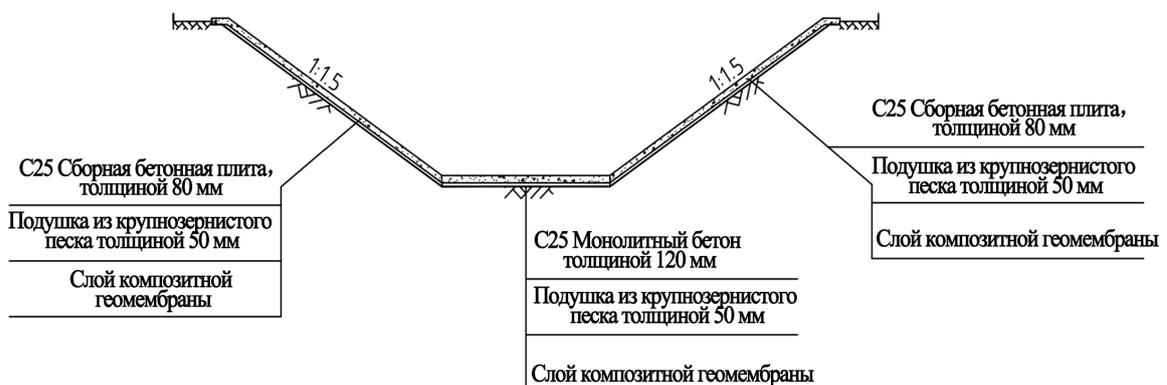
Крепление откосов сборными бетонными плитами по слою геомембраны
